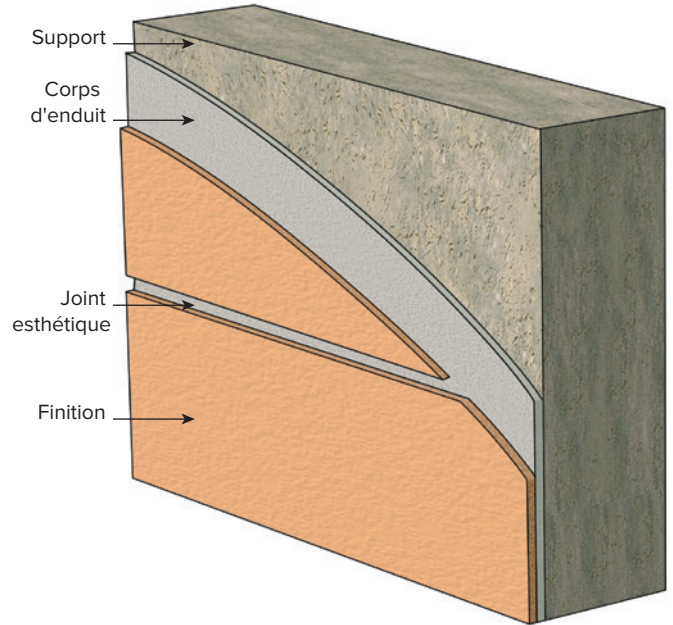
Joint esthétique horizontal (enduit multicouche)
